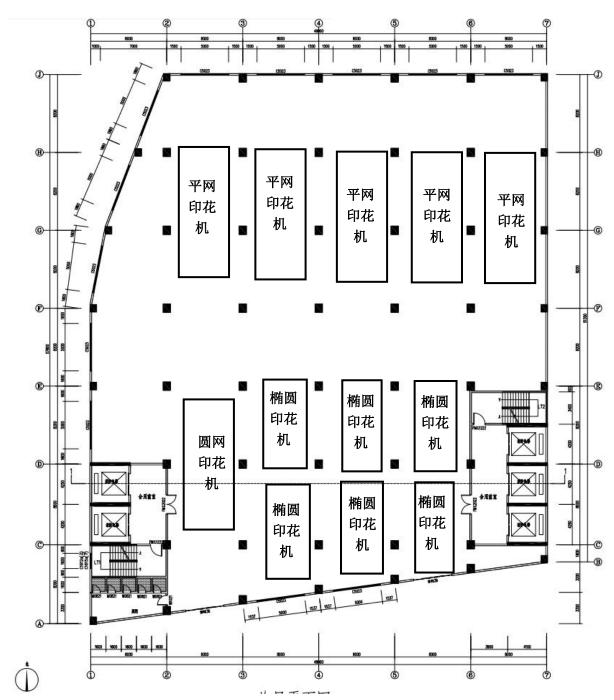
原有项目 (B 栋厂房) 4 楼平面布置图
